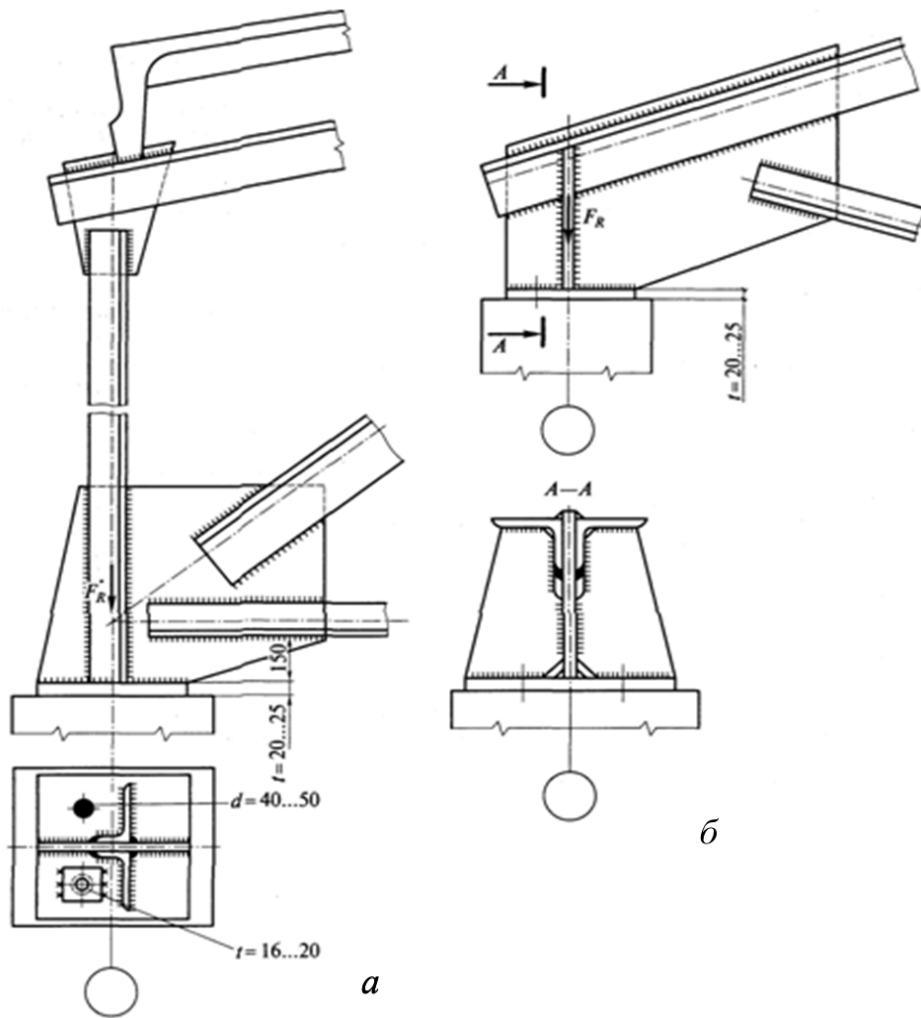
Обпирання ферми на залізобетонну колону:
